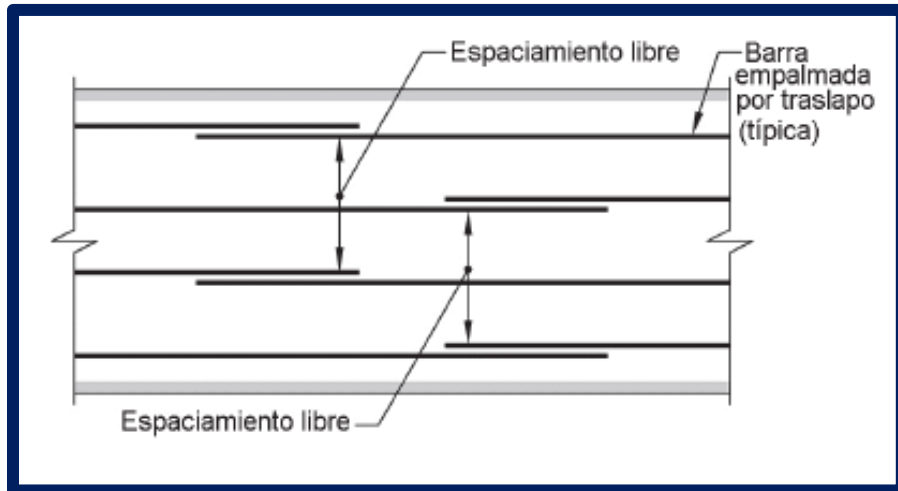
Espaciamiento libre de barras empalmadas para determinar l_d de los empalmes escalonados.
